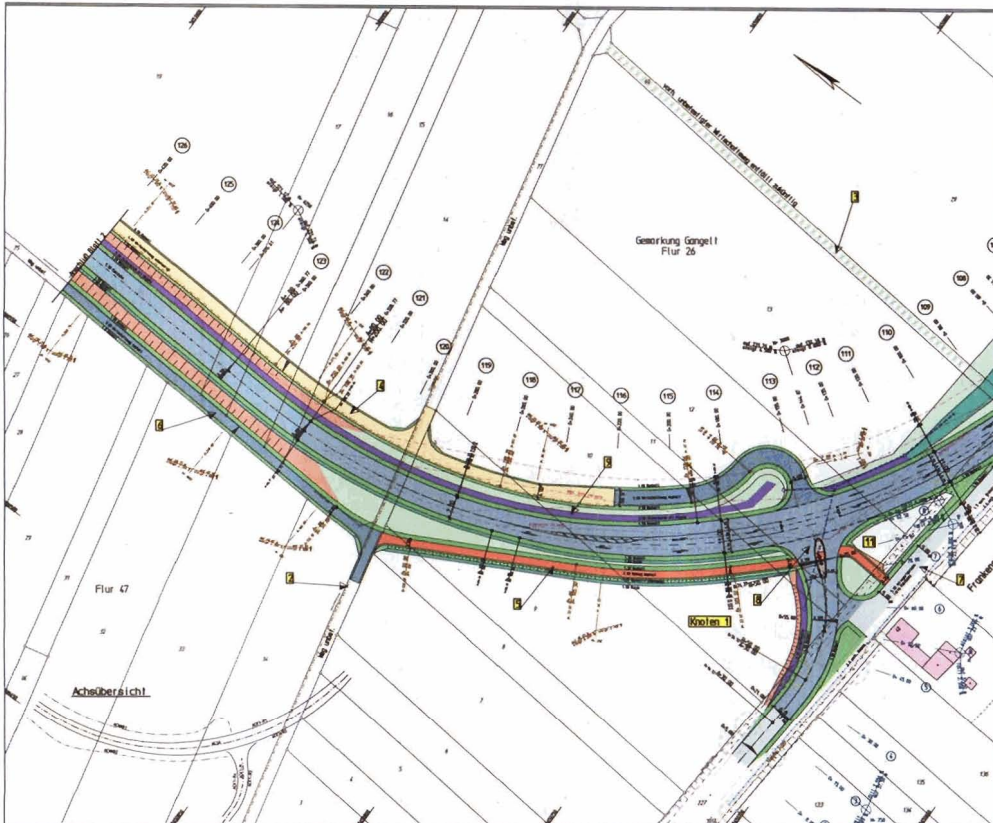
Lageplan und Legende für eine Kreisstraße (Quelle: Kreis Heinsberg).
